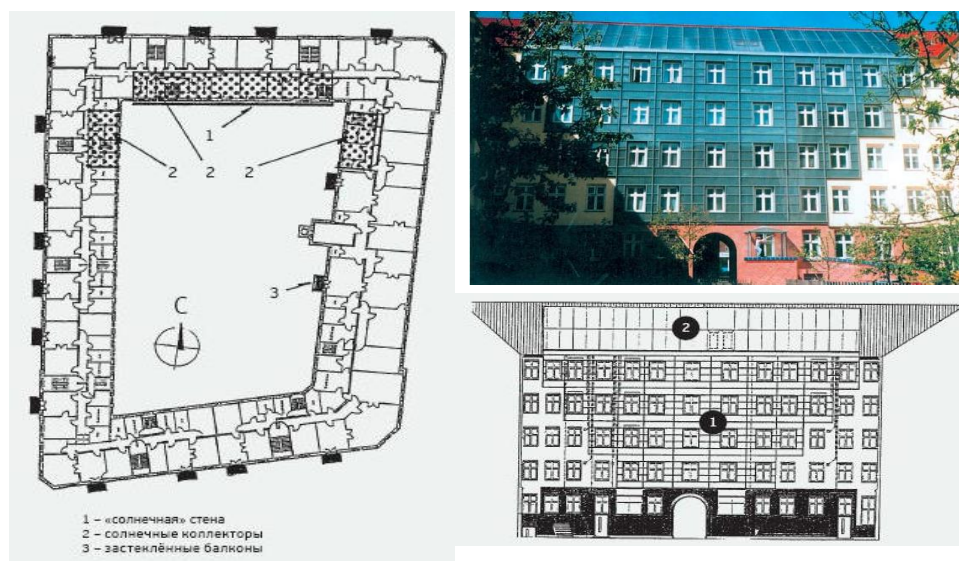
план, 1.8 – фото дворового фасада после реконструкции, 1.9– дворовой фасад после реконструкции
